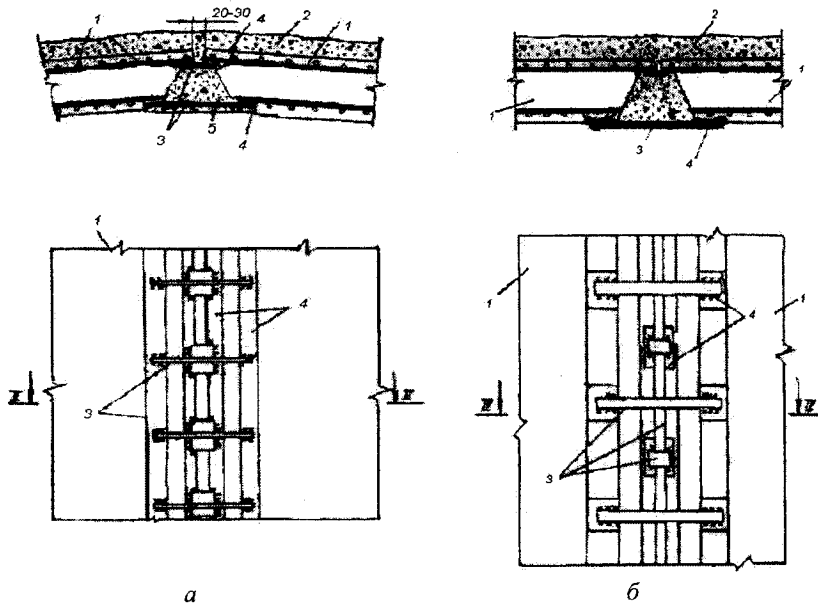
Клиноподібні відкриті стики: *а* – робочий; *б* – неробочий (конструктивний); 1 – панелі, що стикаються; 2 – тампонаж зовнішньої пазухи; 3 – накладки; 4 – закладні частини; 5 – монолітний бетон
